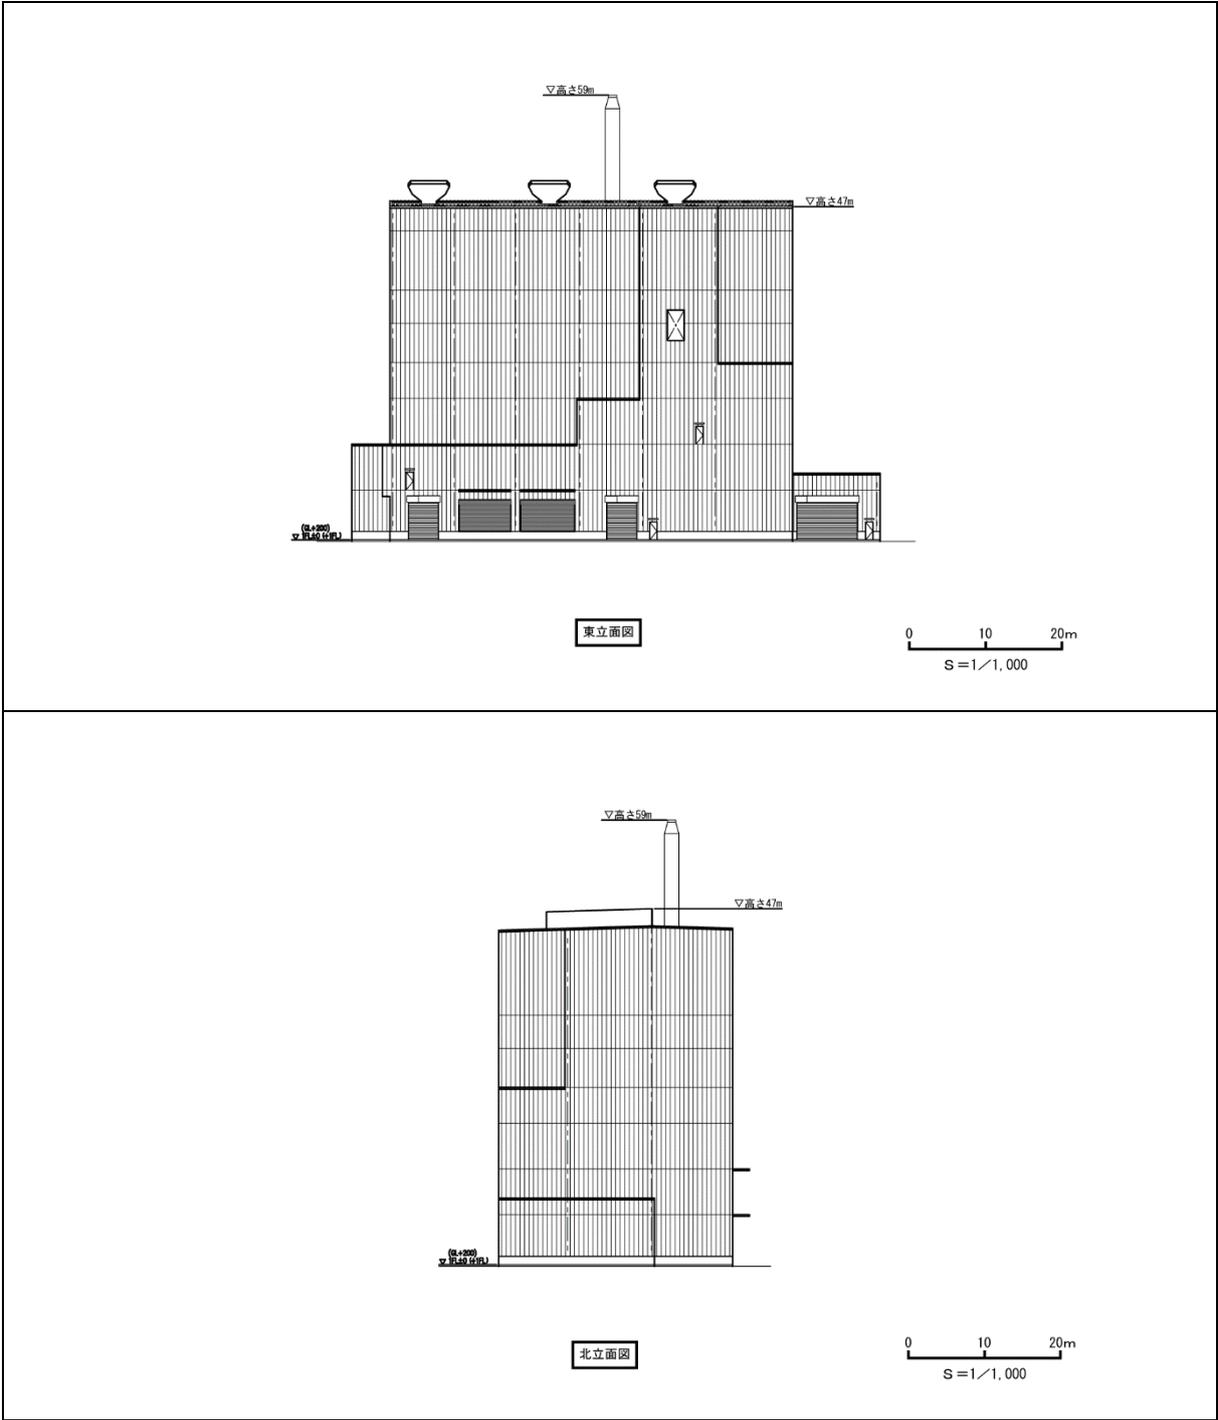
(4) 立面图 (計画施設：Ⅱ期)
